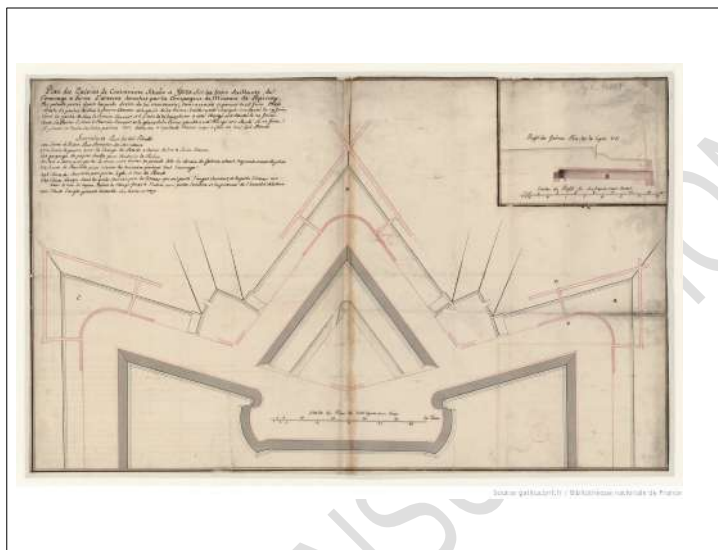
Plan de galerie de contre-mine (en rouge) sur un saillant d'Ypres (source : gallica.bnf.fr).
